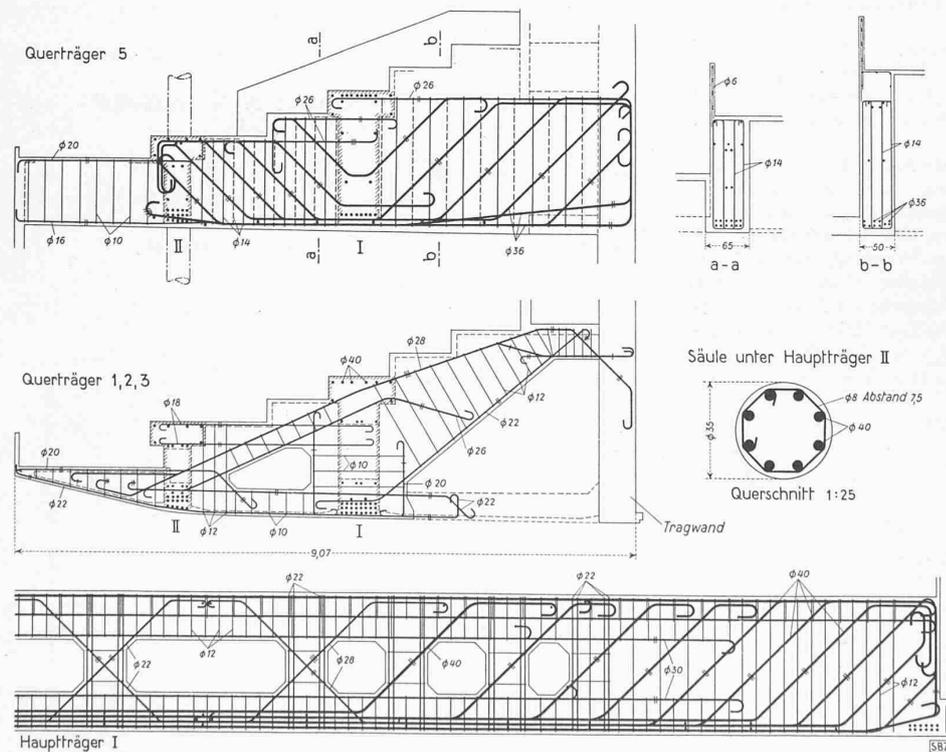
Armierung und Einzelheiten zu Abb. 50. — Masstab 1 : 100
